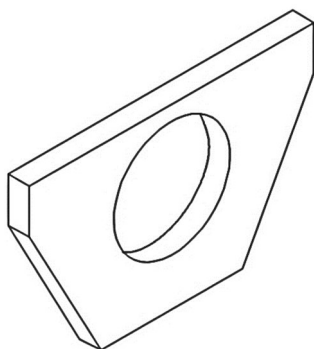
Schemat przepustu rurowego pod zjazdem
